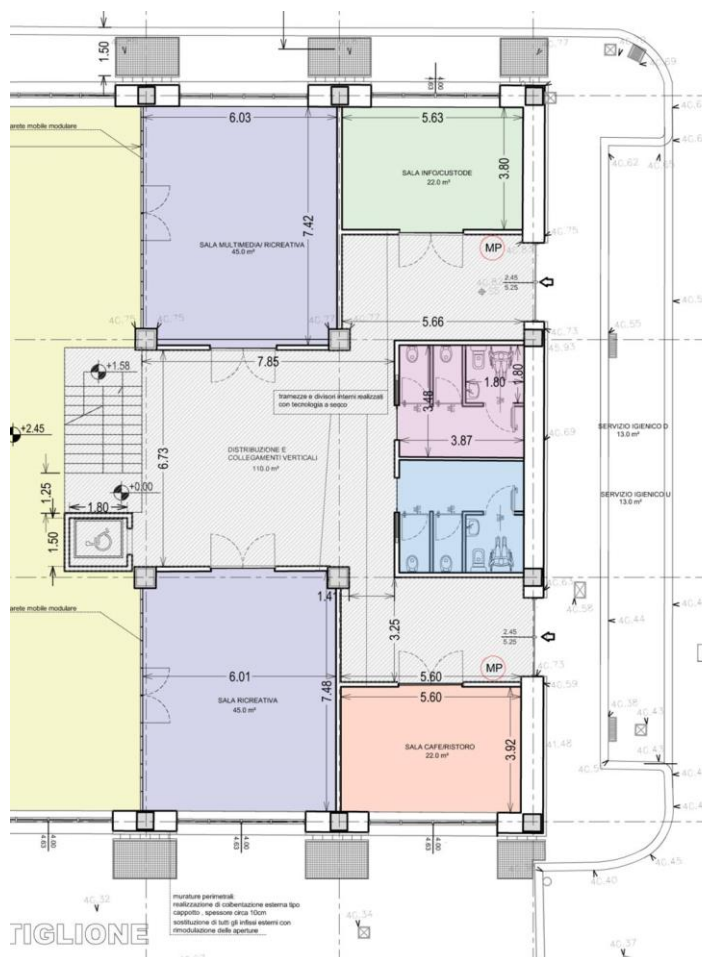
Stralcio planimetrico del piano terra adibito a servizi di quartiere
